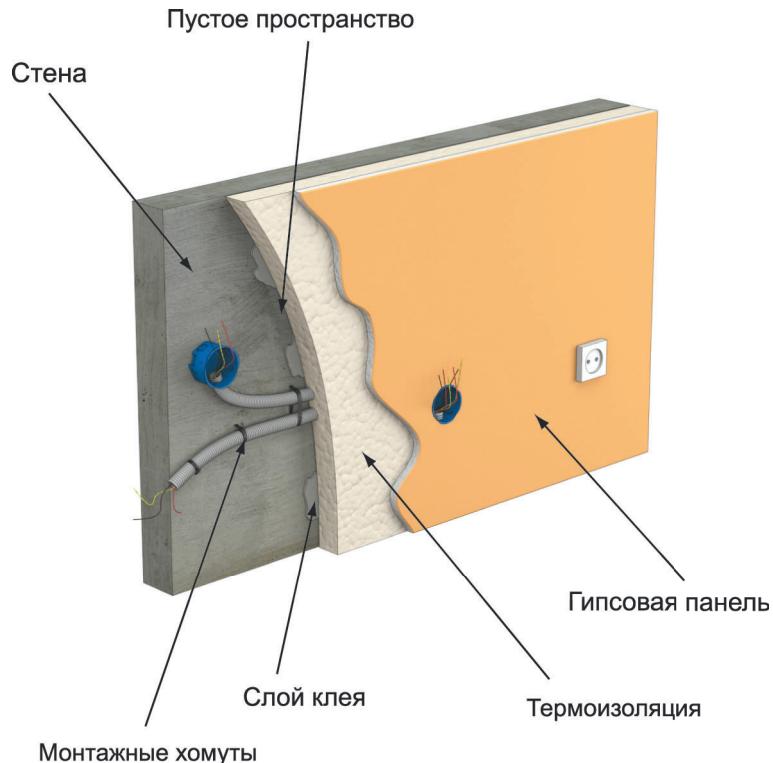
Укладка кабеля в гипсокартонной перегородке
